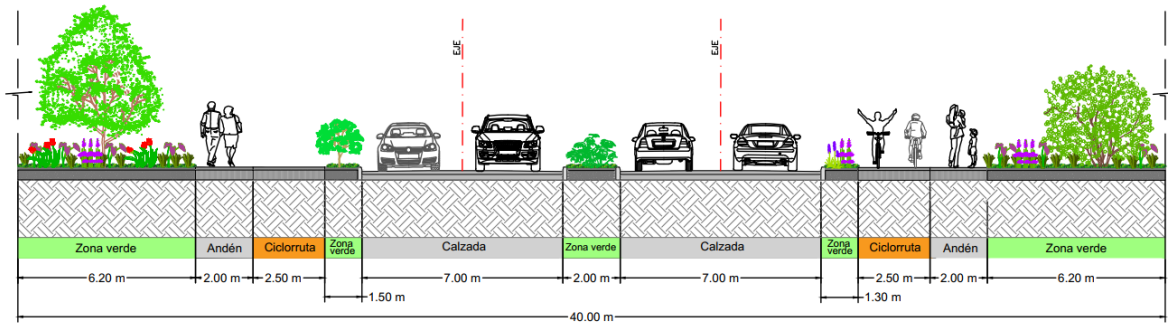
Sección vial propuesta vía Kakaraca – Ipanema – Casa Mía.
